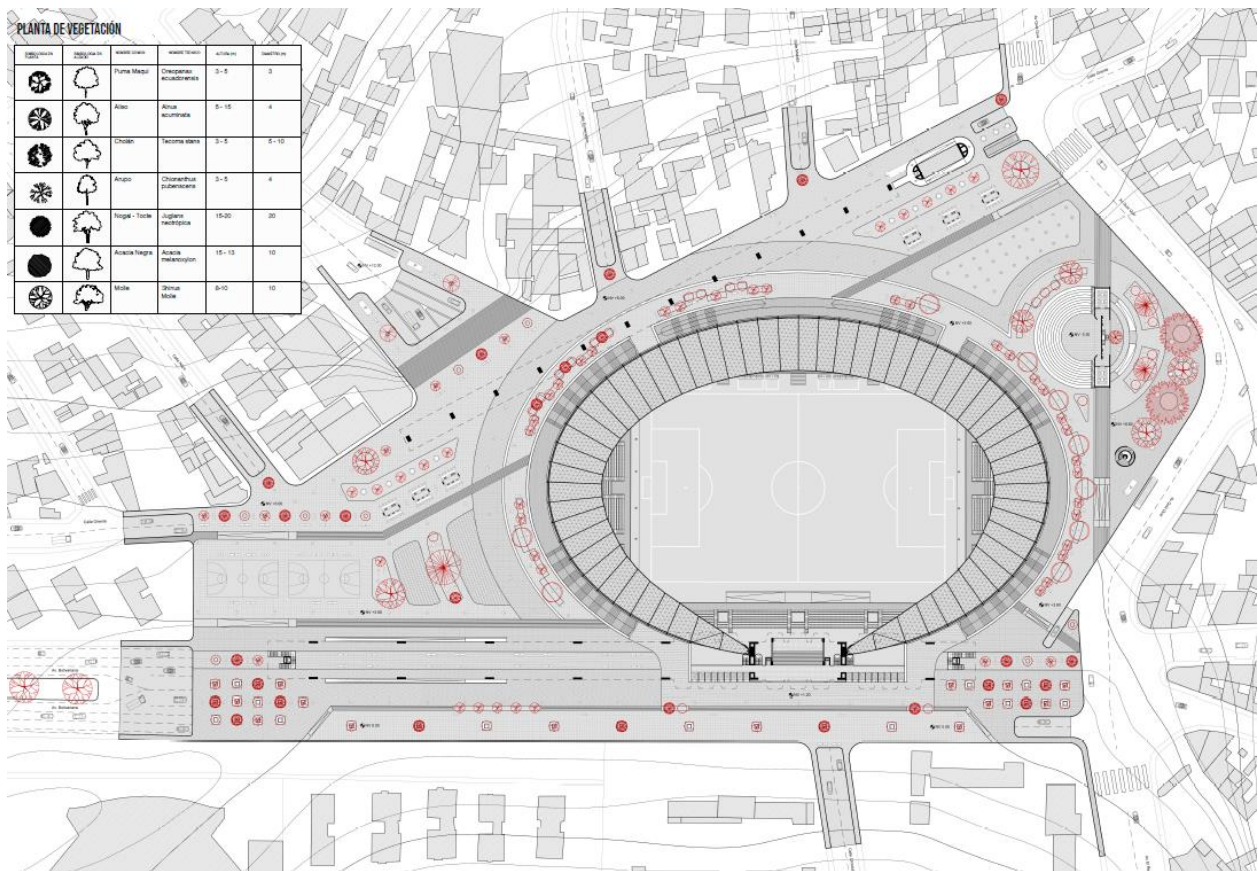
Planta baja de paisaje. Fuente: Elaboración propia (2019)
